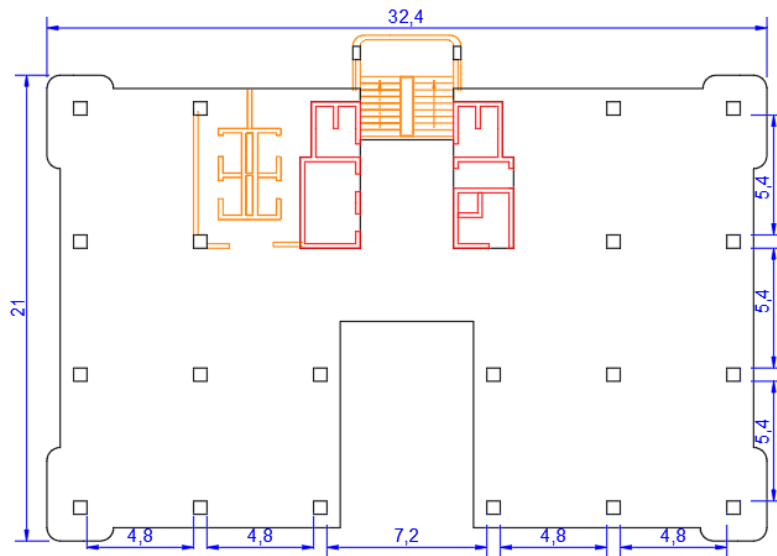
Esquema de la planta tipo, de las plantas Segunda a la Octava del EERCs.
